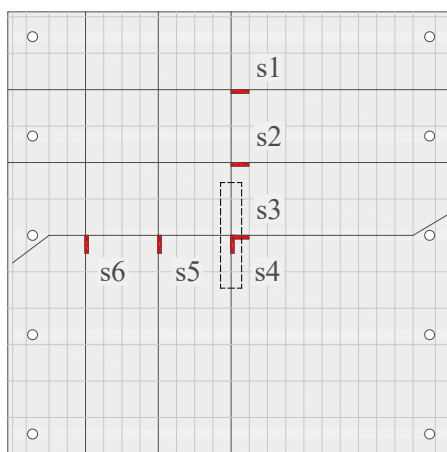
Posição dos extensômetros instalados nas armaduras
